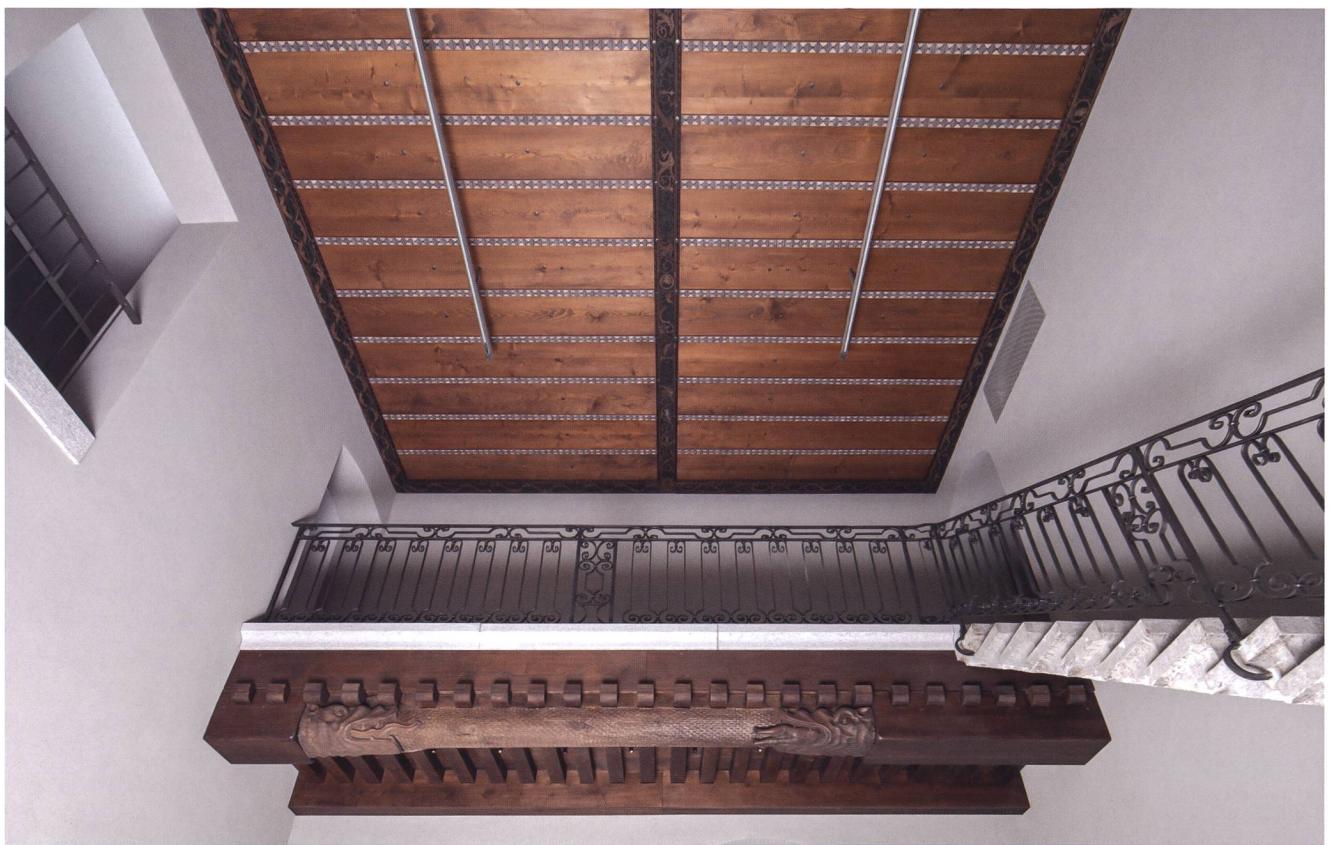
Teilrekonstruierte Decken nach dem Wiedereinbau im Lichthof des Landesmuseums. Decke aus dem Schloss Neunkirch (oben) und dem Schloss Promenthal (unten), Landesmuseum Zürich.
